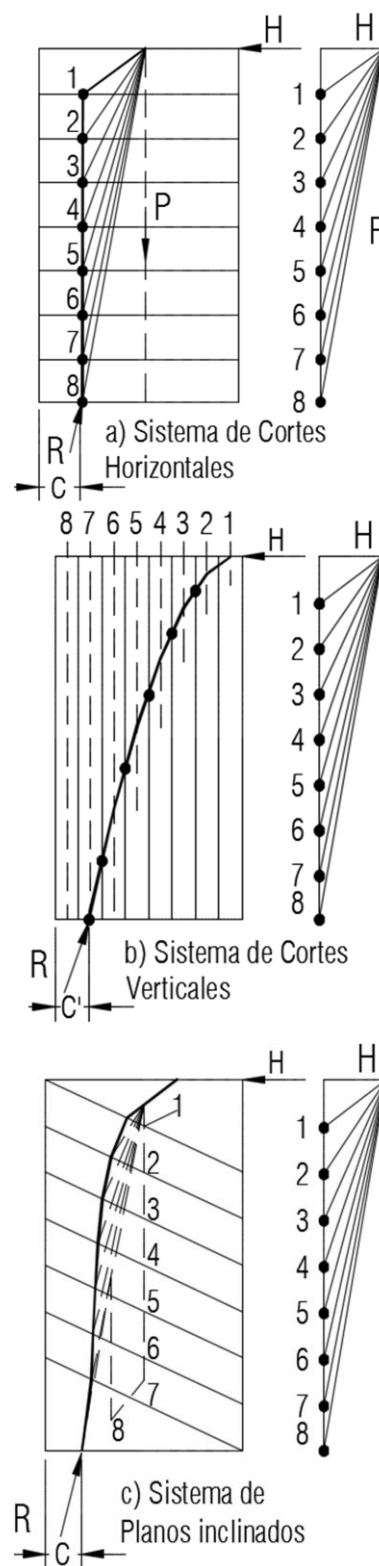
Sistemas de planos corte en un estribo rectangular
